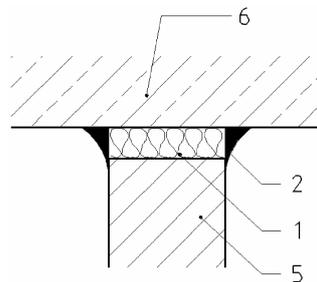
Beweglicher Anschluss zwischen tragenden Mauerwerk- und Betonwänden (oder -pfeilern)
